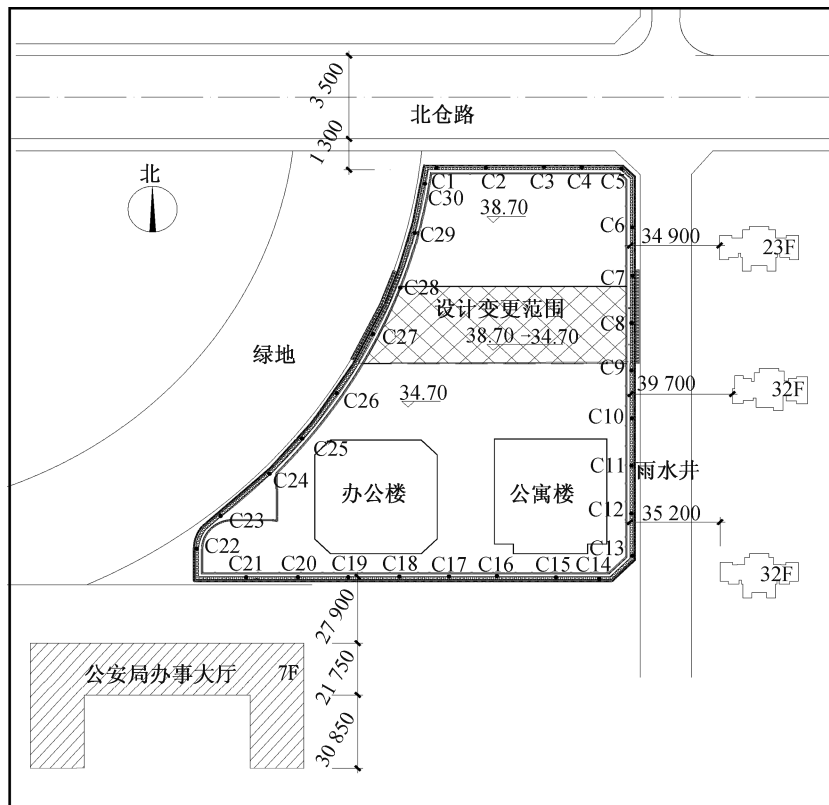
基坑周边环境及主要监测点布置图(单位:mm)
